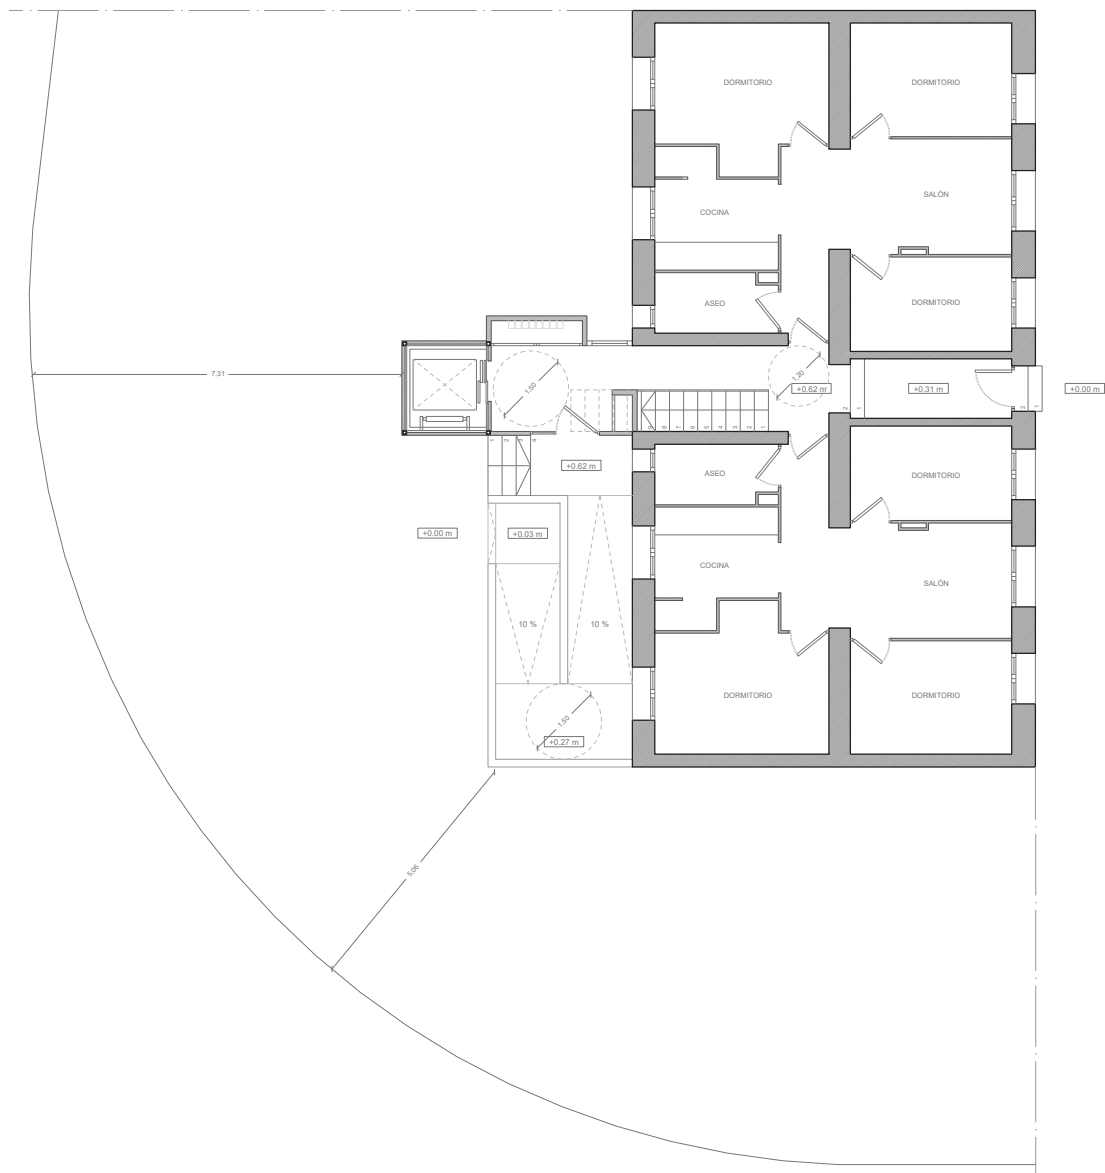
Zoom núcleo planta baja (e: 1/150).
